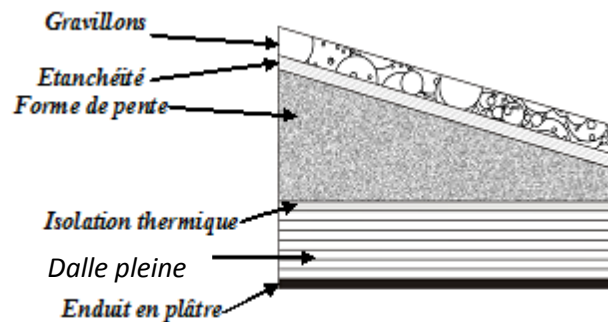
Plancher terrasse inaccessible et couvre les conduites de refoulement
